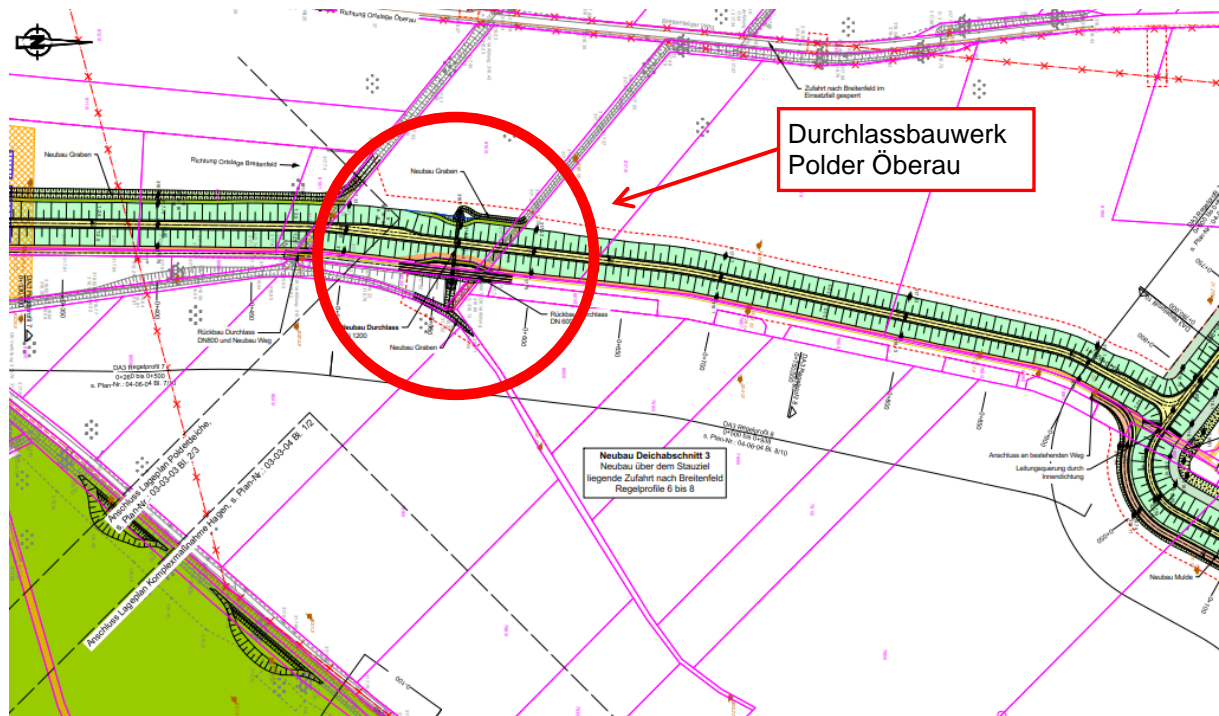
Durchlassbauwerk Polder Öberau, Lageplan (aus Plan 03-03-03, Blatt 3/3)
